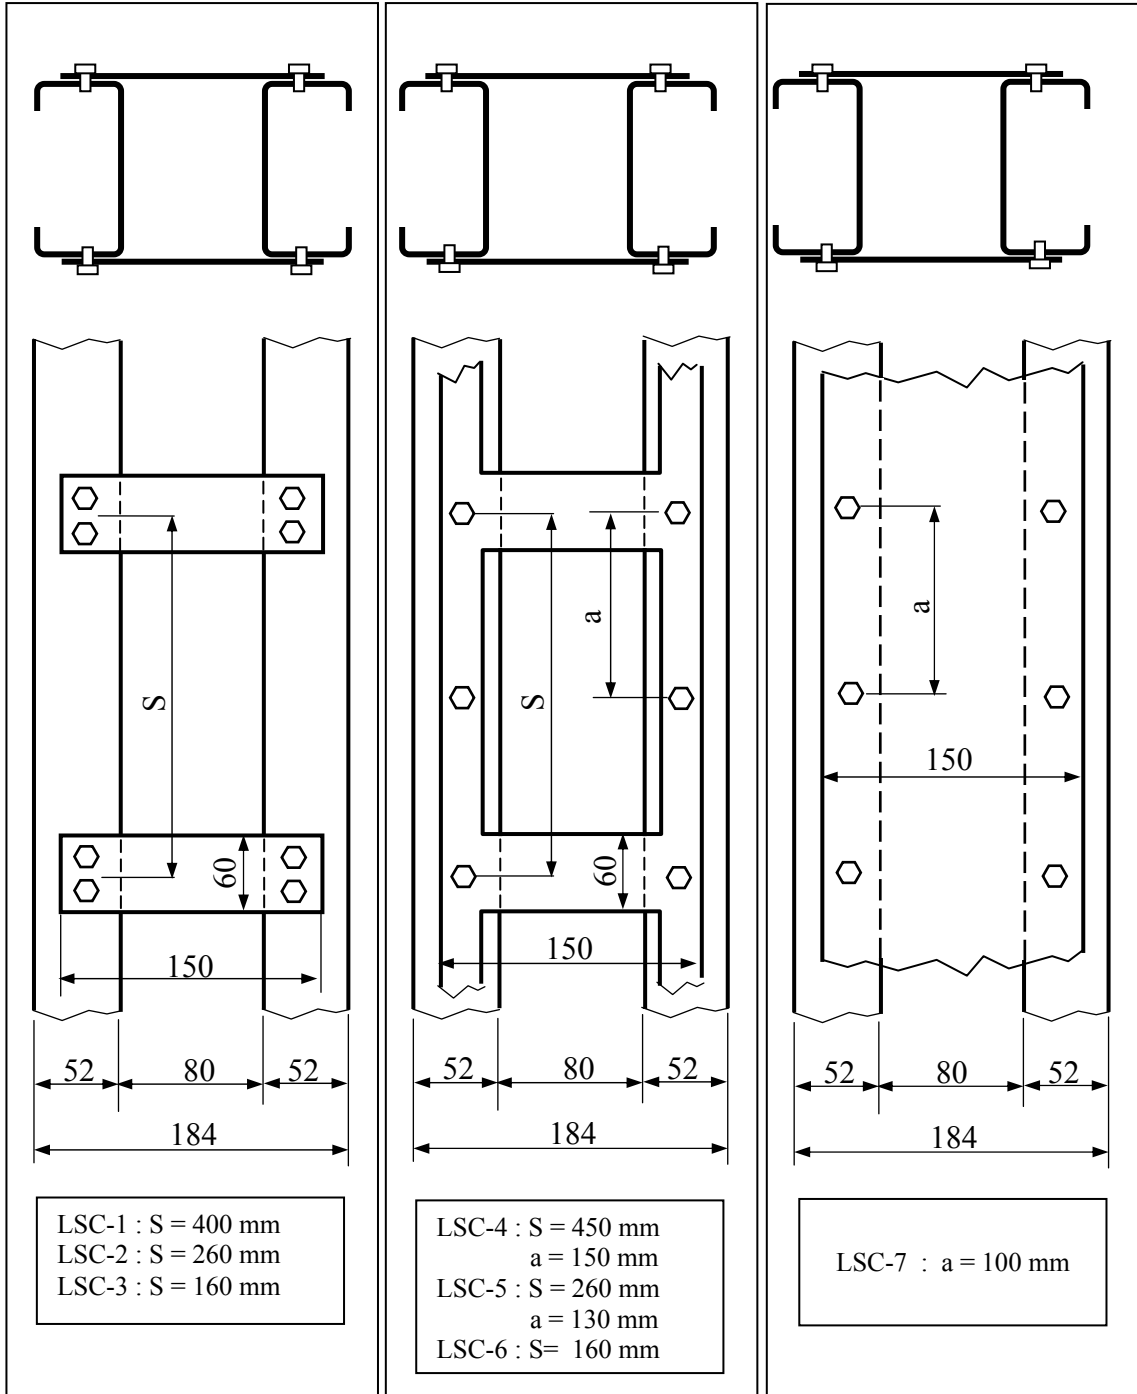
Kolon üretiminde kullanılan profillerin kesiti
